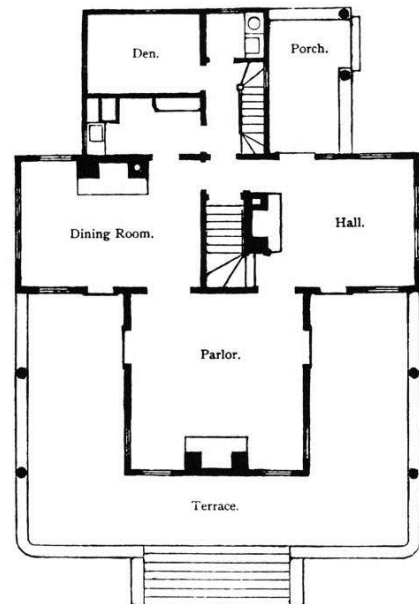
Casa Kent, 1885. Planta primera. Fuente: Principios de la arquitectura moderna.
